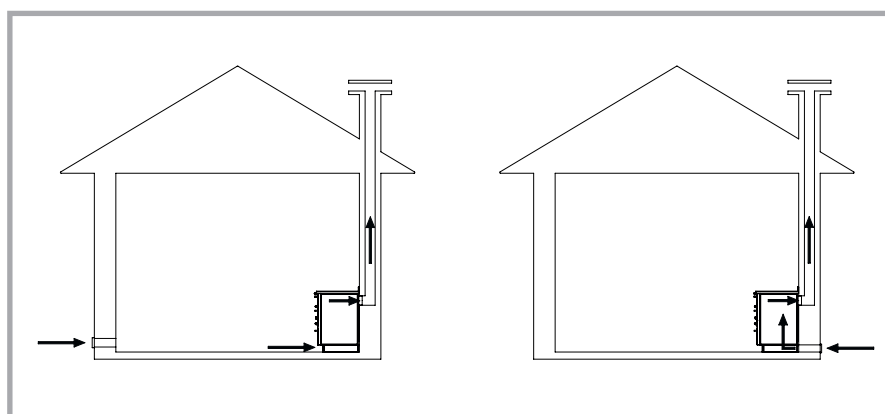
Installazione mediante presa d'aria nel locale e installazione con presa d'aria esterna collegata direttamente alla termocucina a legna.
